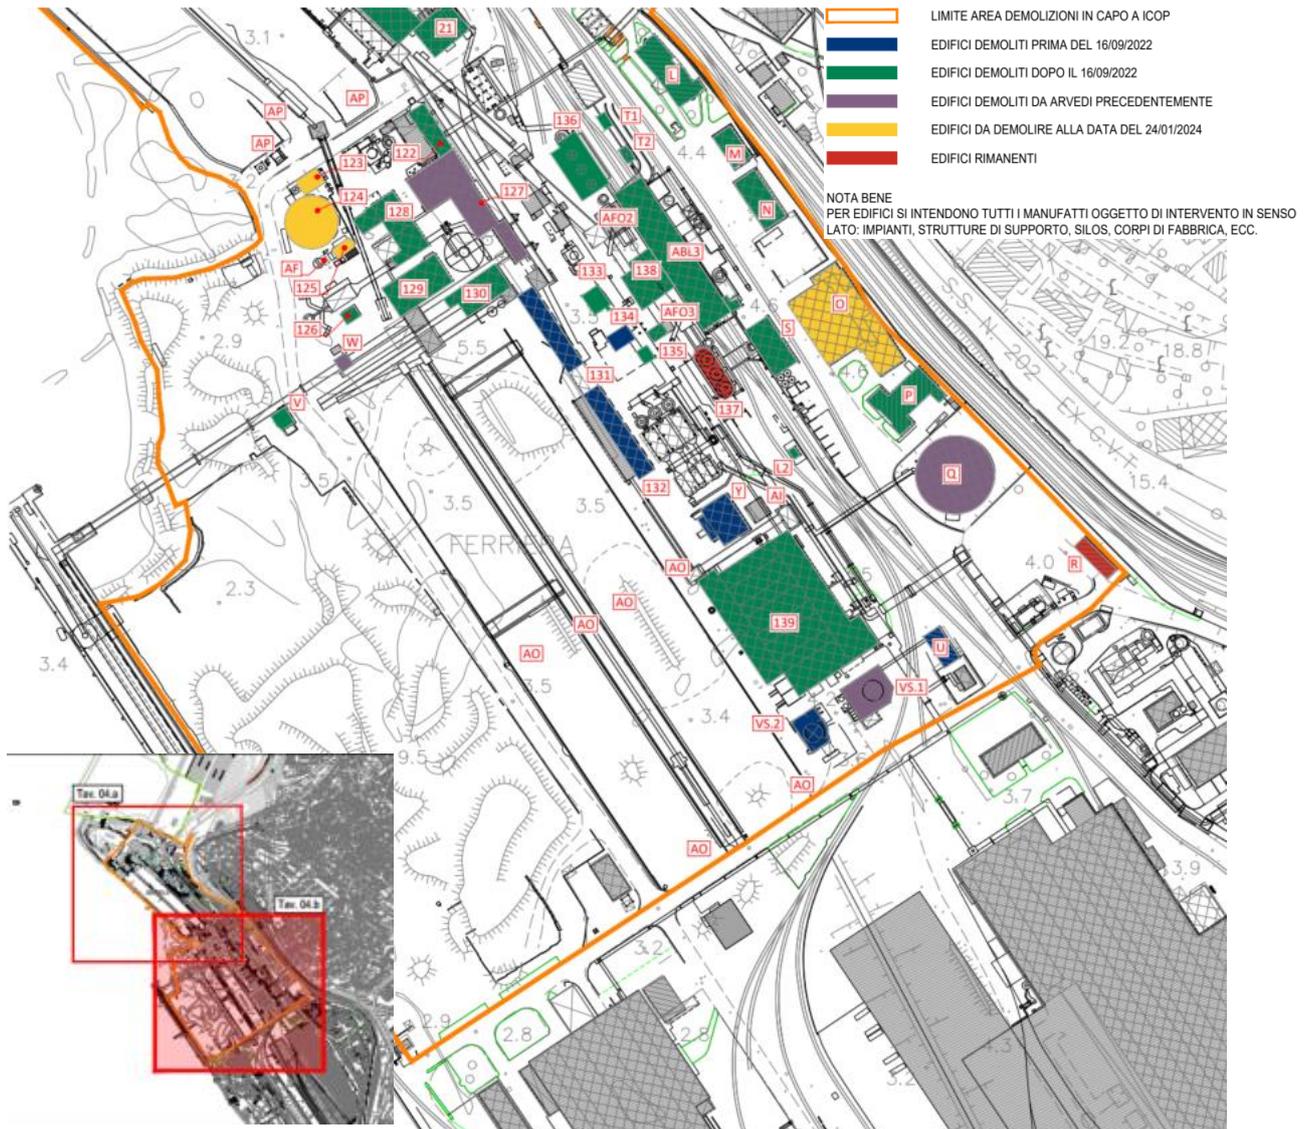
situazione delle demolizioni approvate con decreto 522/2021 a tutto gennaio 2024 nella porzione del cantiere più a sud: i lavori sono ultimati a meno dell'edificio R (una cabina elettrica in funzione) e a meno dei cowpers (complesso 137 che deve essere preservato come reperto di archeologia industriale) evidenziati in rosso e a meno degli edifici evidenziati in giallo di prossima demolizione. Tranne le aree che erano e tuttora sono destinate alla viabilità che sono asfaltate, il resto delle aree di cantiere è stato protetto da un geotessile non tessuto e da uno spessore di ghiaio per escludere l'esposizione degli operatori ai percorsi diretti.
